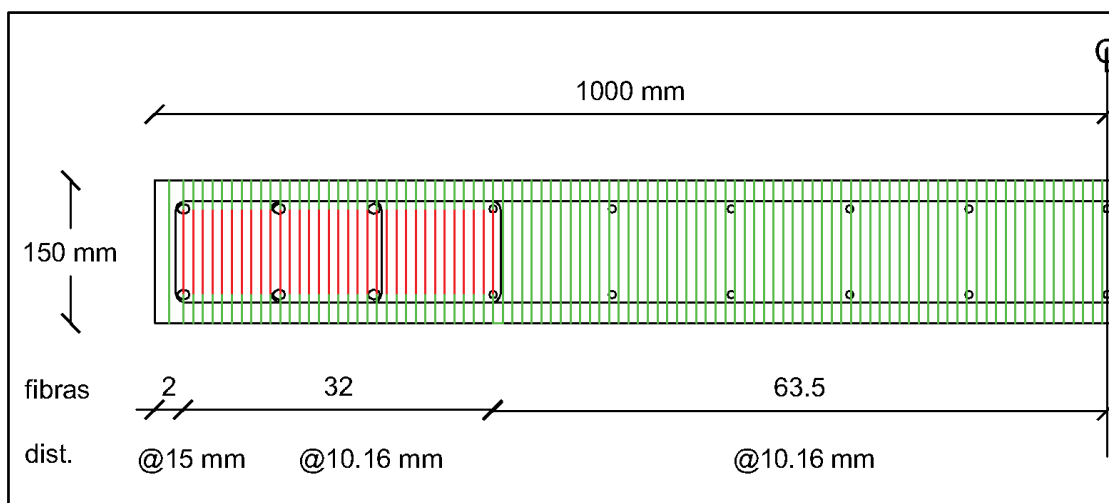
Discretización en fibras de la sección del muro WSH6 para el FBE. Rojo: fibras hormigón confinado. Verde: fibras hormigón no confinado. Círculos: fibras de acero.
